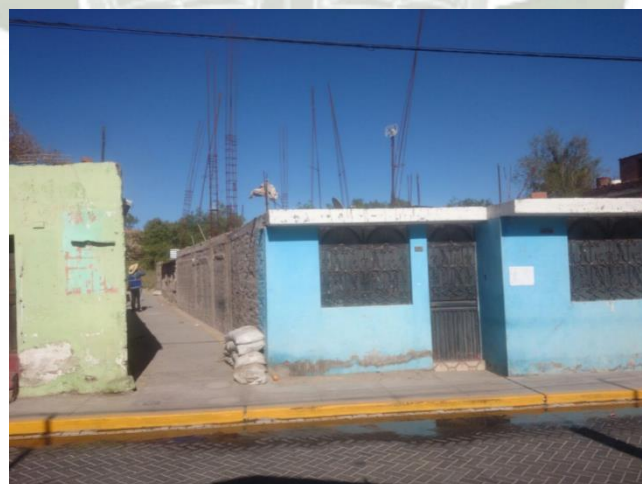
Vivienda que presenta acero de refuerzo longitudinal y transversal de columna expuesto (Y-12)
